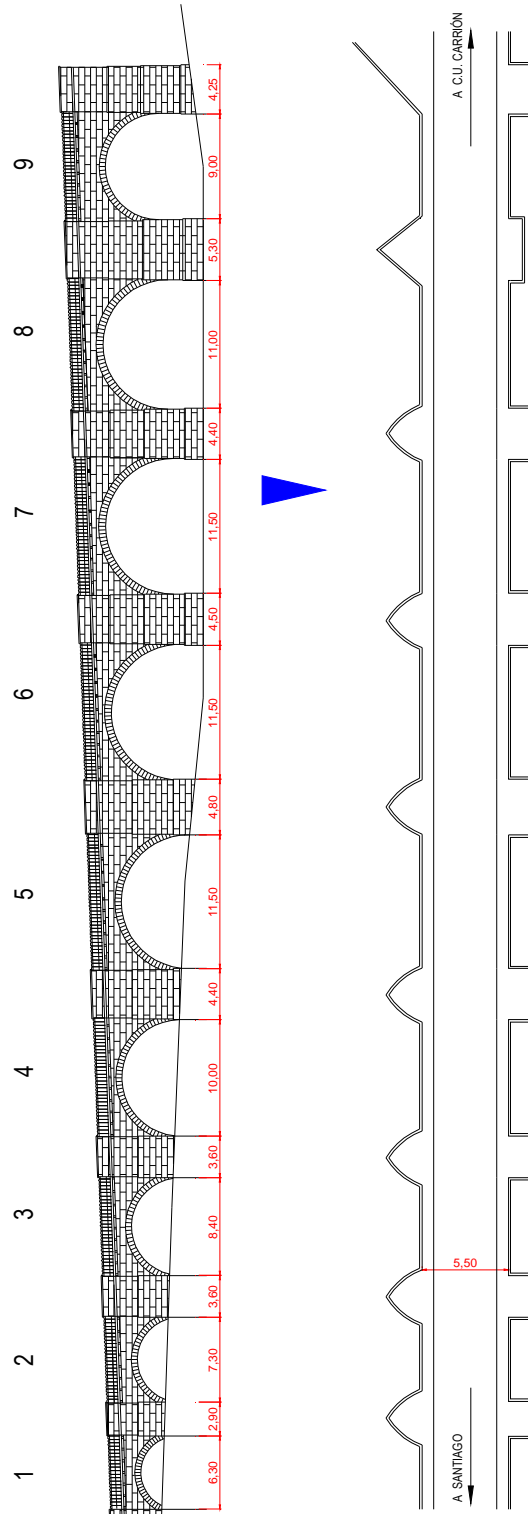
Dibujo de planta y alzado del puente en Carrión de los Condes.
